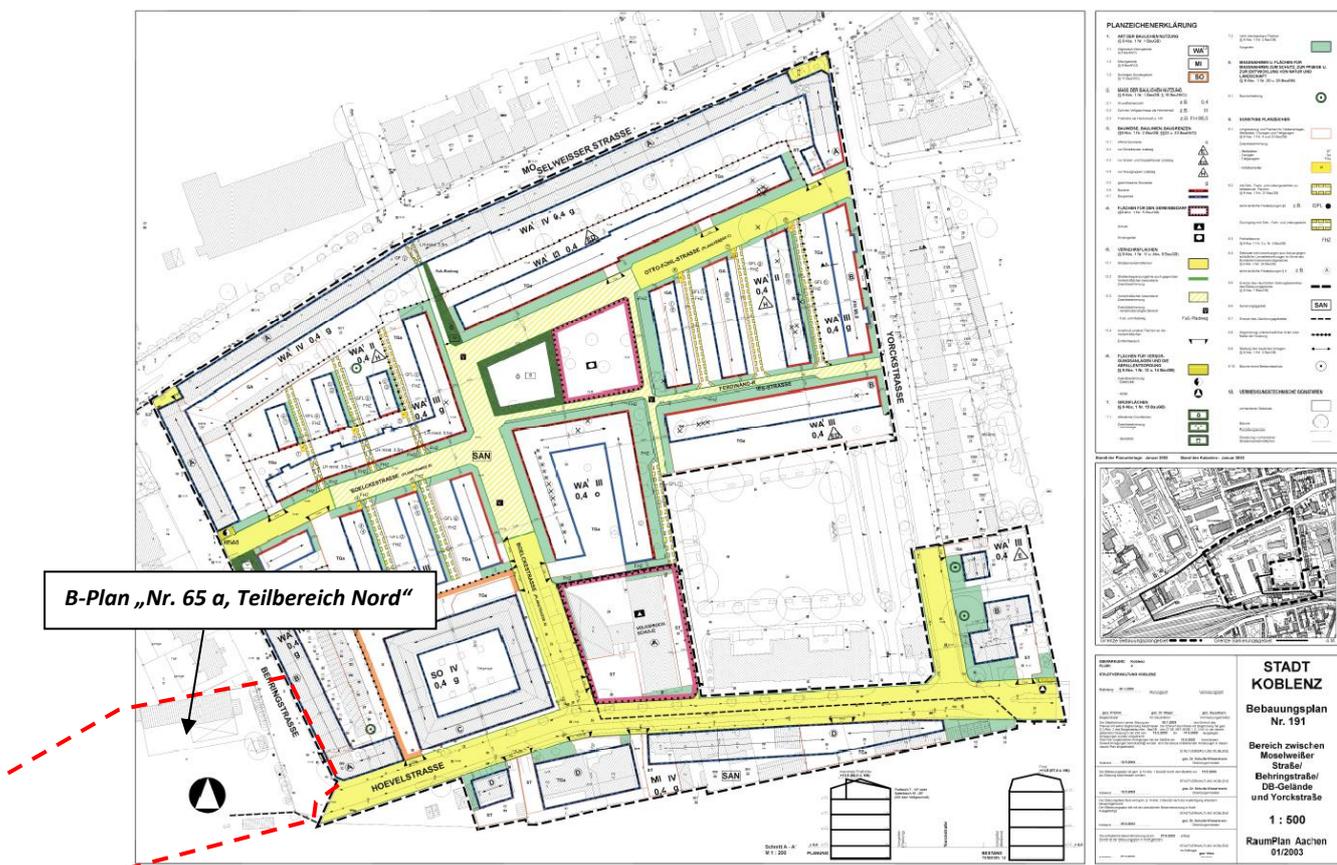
Bebauungsplan Nr. 191: „Bereich zwischen Moselweißer Straße / Behringstraße / DB-Gelände und Yorkstraße“
